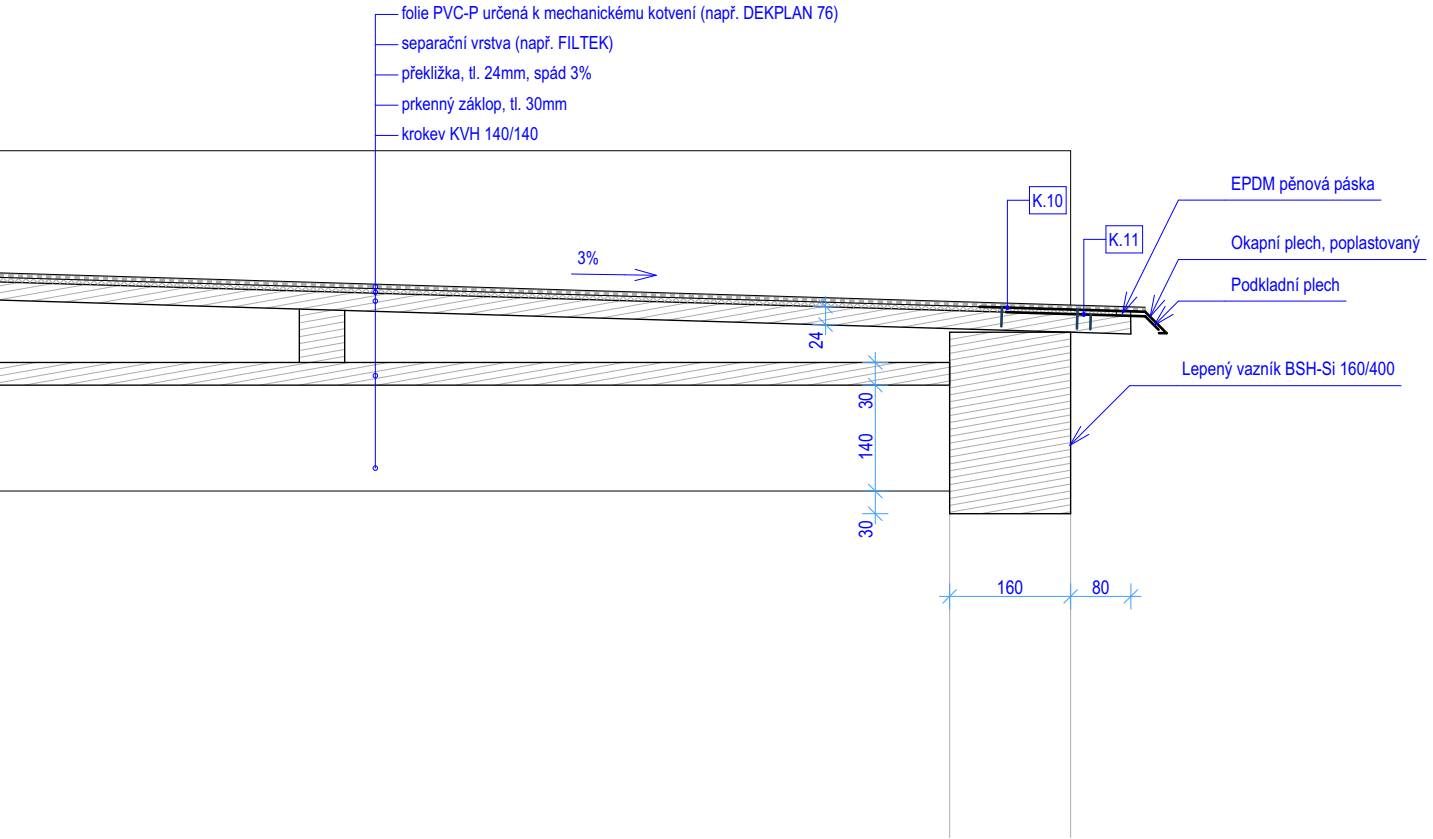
### DETAIL UKONČENÍ U STĚNY - ŘEZ PŘÍČNÝ
